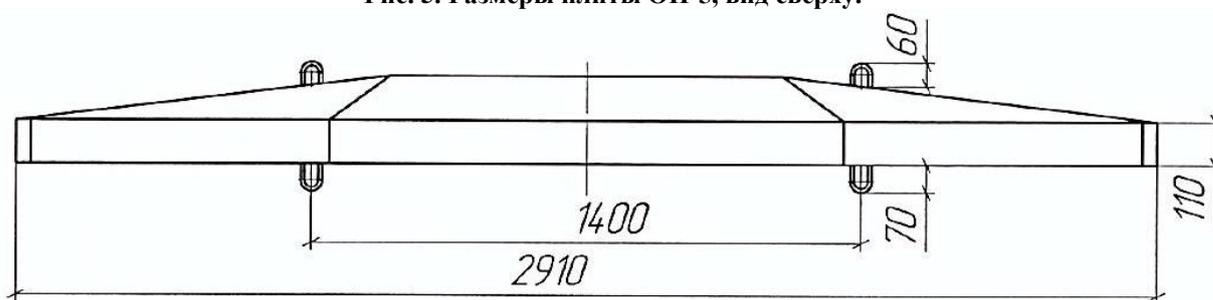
Размеры плиты ОП-5, вид сбоку.
